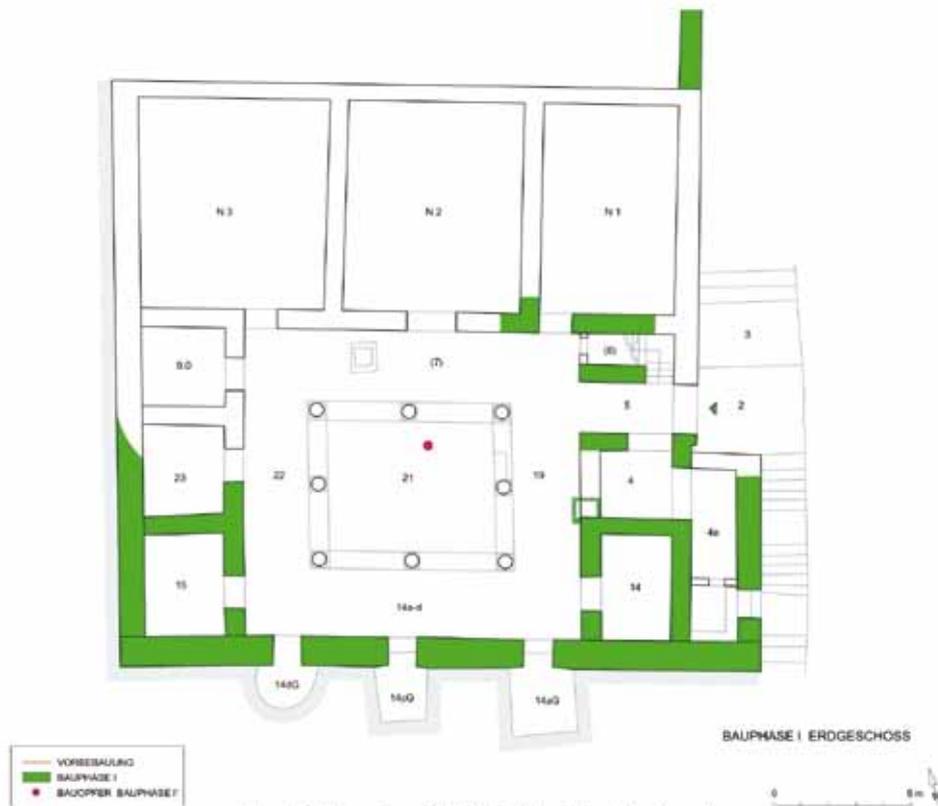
Hanghaus 2, WE 4, Grundriss Bauphase I
